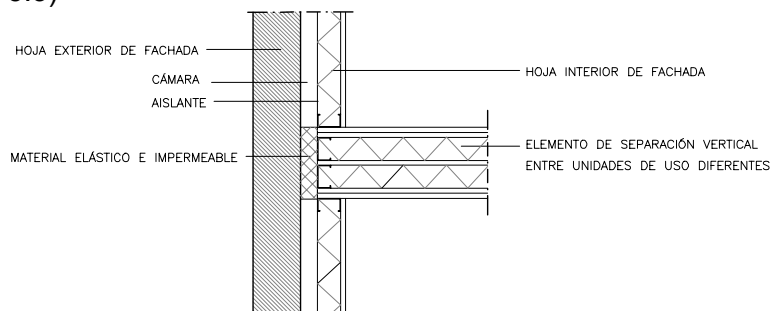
Encuentro de un elemento de separación de placas de yeso laminado con la fachada
